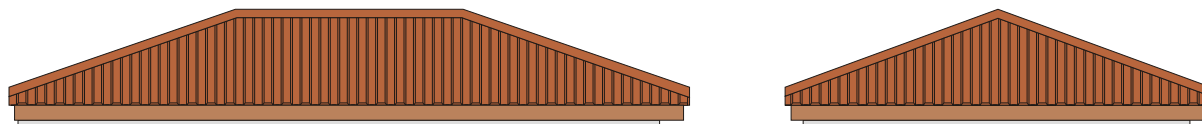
DACH W WARIANCIE „0” /PODSTAWOWY/ - DACH BETONOWY DWUSPADOWY ( STROPODACH).
